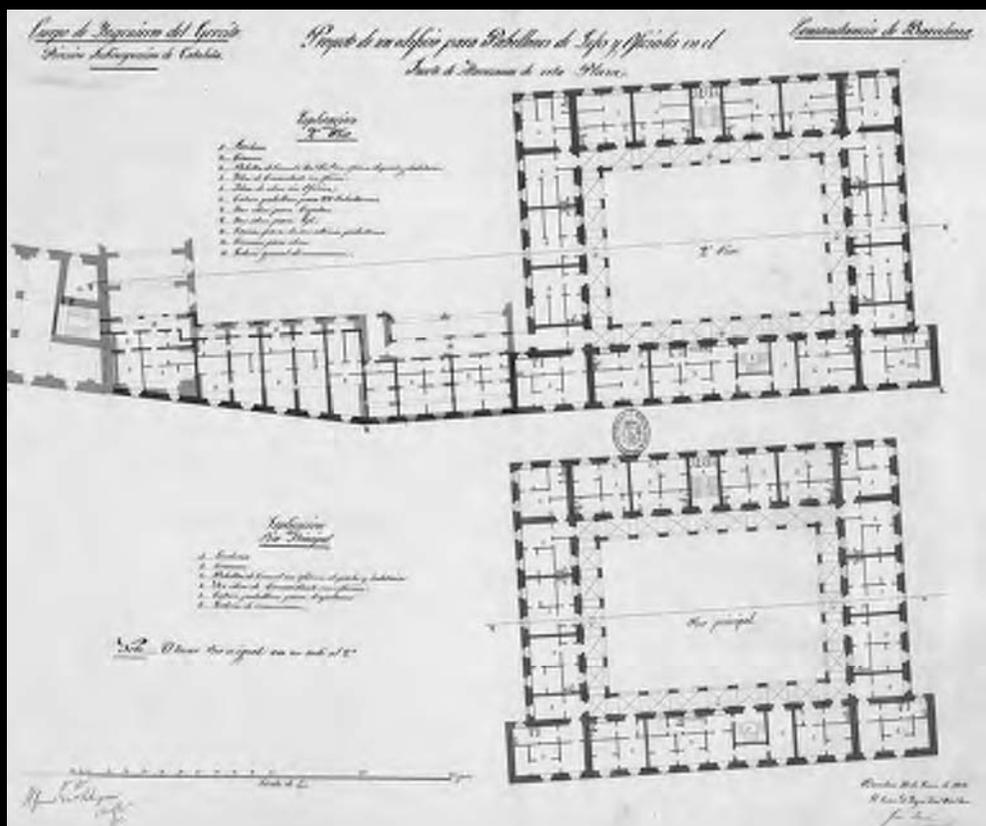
Planta principal y segunda y tercera planta de los pabellones. Juan Porcel. 1858. IHCM. Cartoteca B-34-11.
